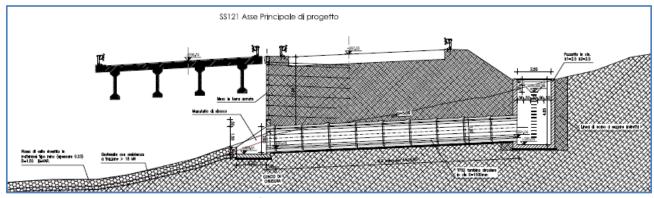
Profilo longitudinale tombino idraulico TP52.
